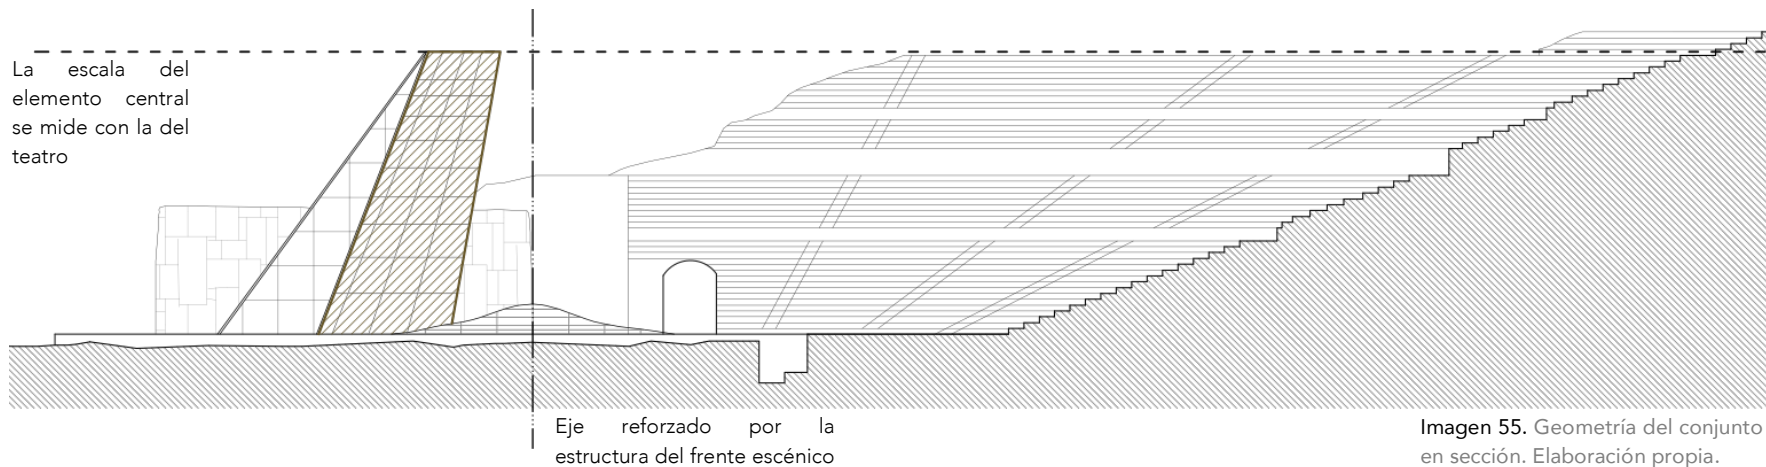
Geometría del conjunto en sección. Elaboración propia.
